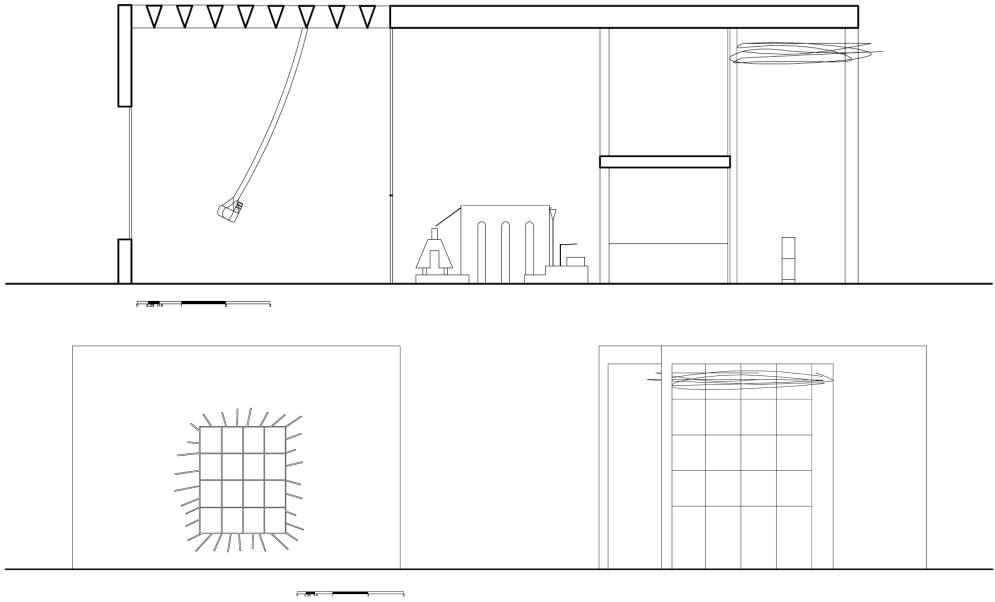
, 450, 451, 452. Enrique Martínez-Díaz, Planos de planta baja, primera, Sección y Alzados de la "Casa para Juan Navarro Baldeweg", 2014
